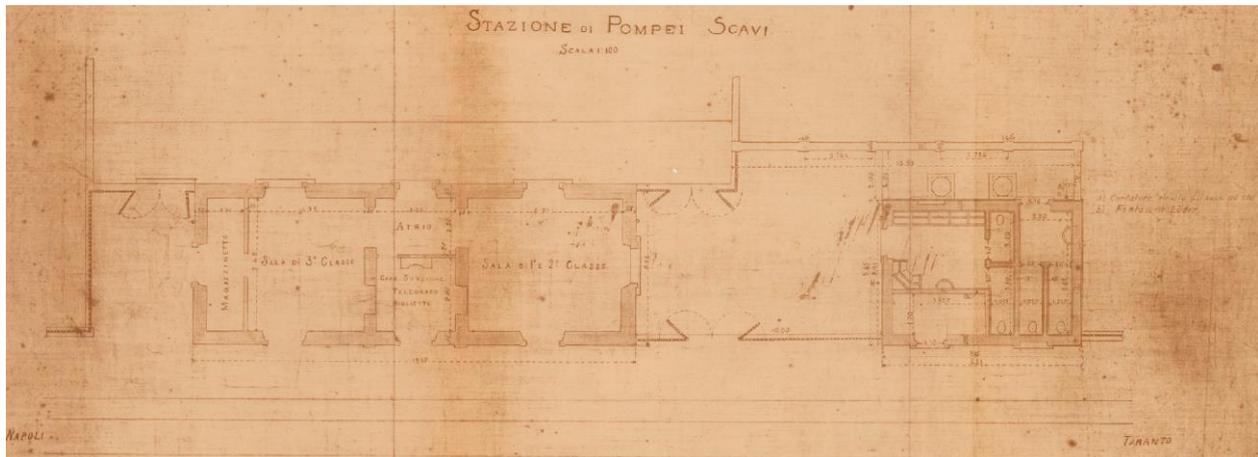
planimetria dei fabbricati della Ex fermata di Pompei scavi - fonte archivio storico FS
